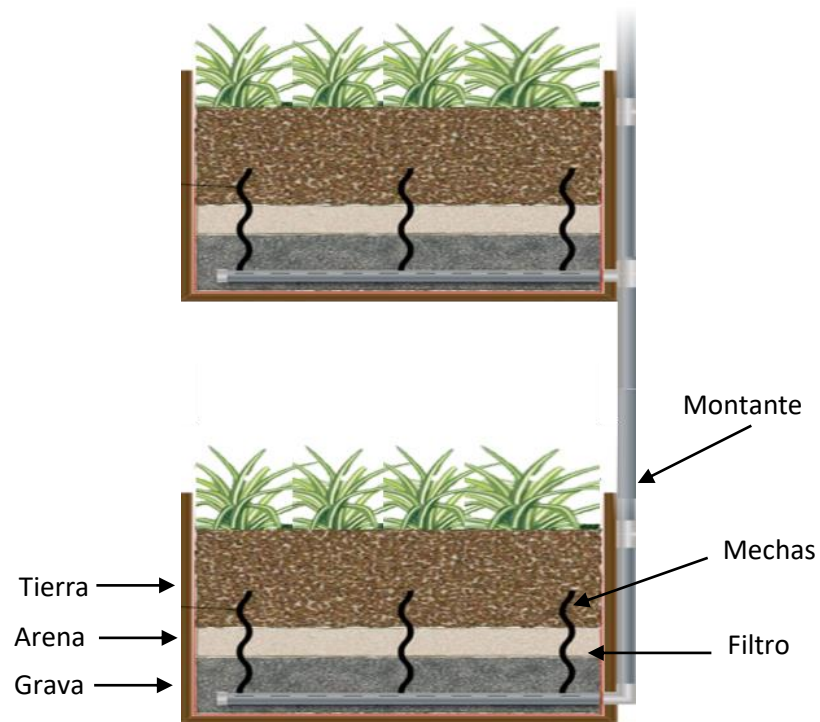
Detalle de Riego y Drenaje en Jardineras
